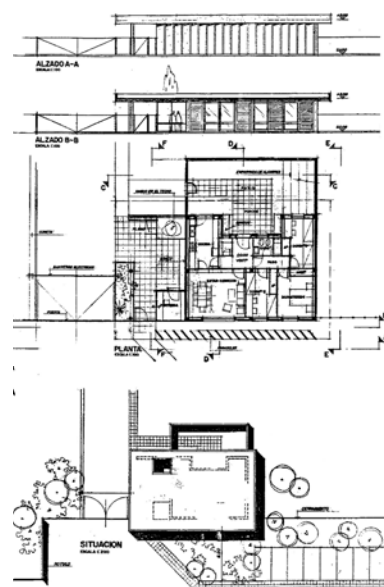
, Fig. 52, Fig. 53 y Fig. 54 Portero y acceso al conjunto. De arriba a abajo: alzado principal del pabellón, alzado principal del pabellón tras los parasoles, planta de la vivienda y planta de situación.
